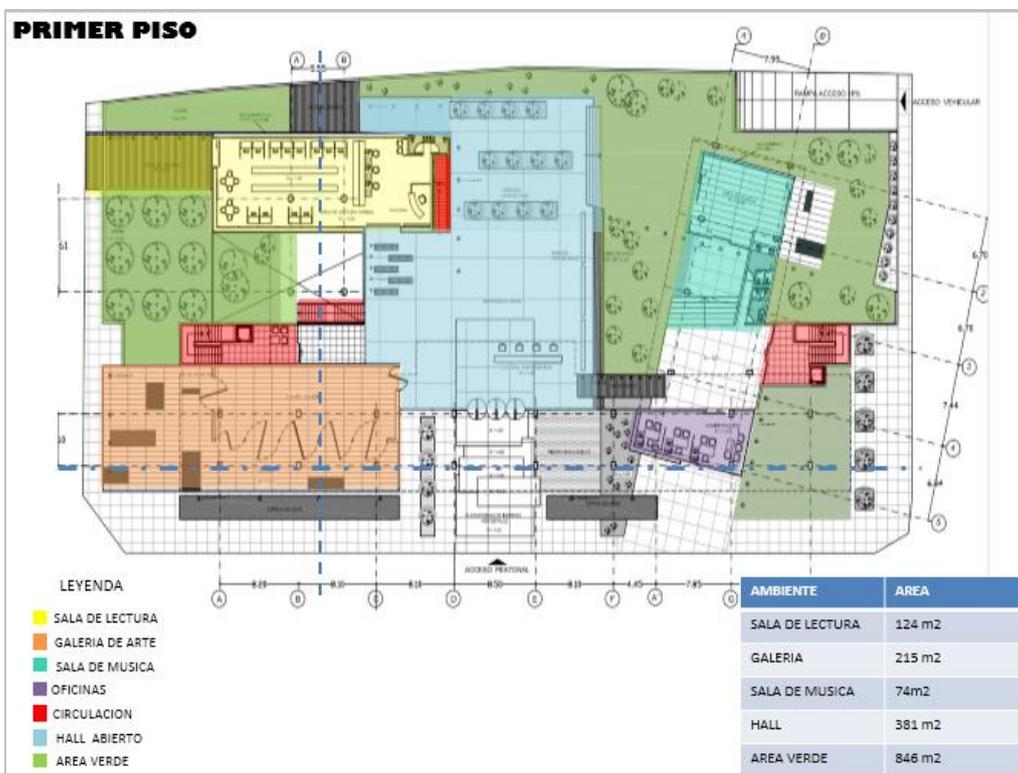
Zonificación Ira Planta- Residencia Quito. Fuente: Propia
